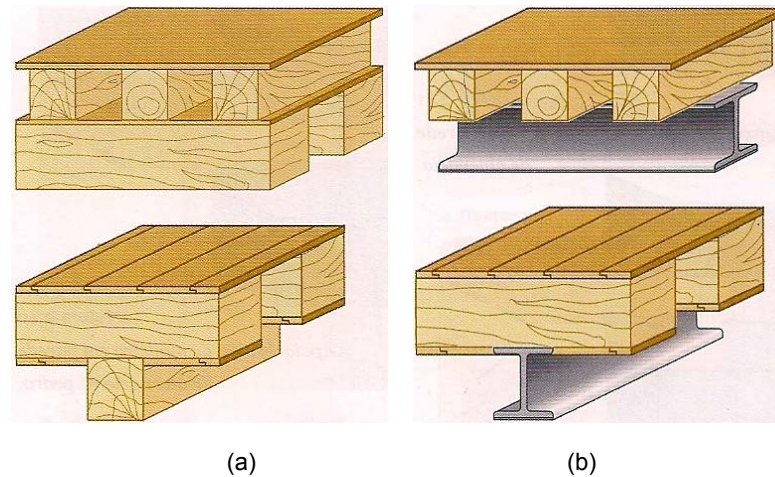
Pavimento de vãos múltiplos (a) viga em madeira; (b) viga em ferro [1].
